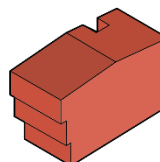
Representación de evolución de vivienda de un nivel a dos niveles que pasa de cubierta inclinada a cubierta plana usada como terraza y futura construcción de otros niveles. *Elaboración propia a partir de* (Tarchópulos Sierra & Ceballos Ramos, 2003).
